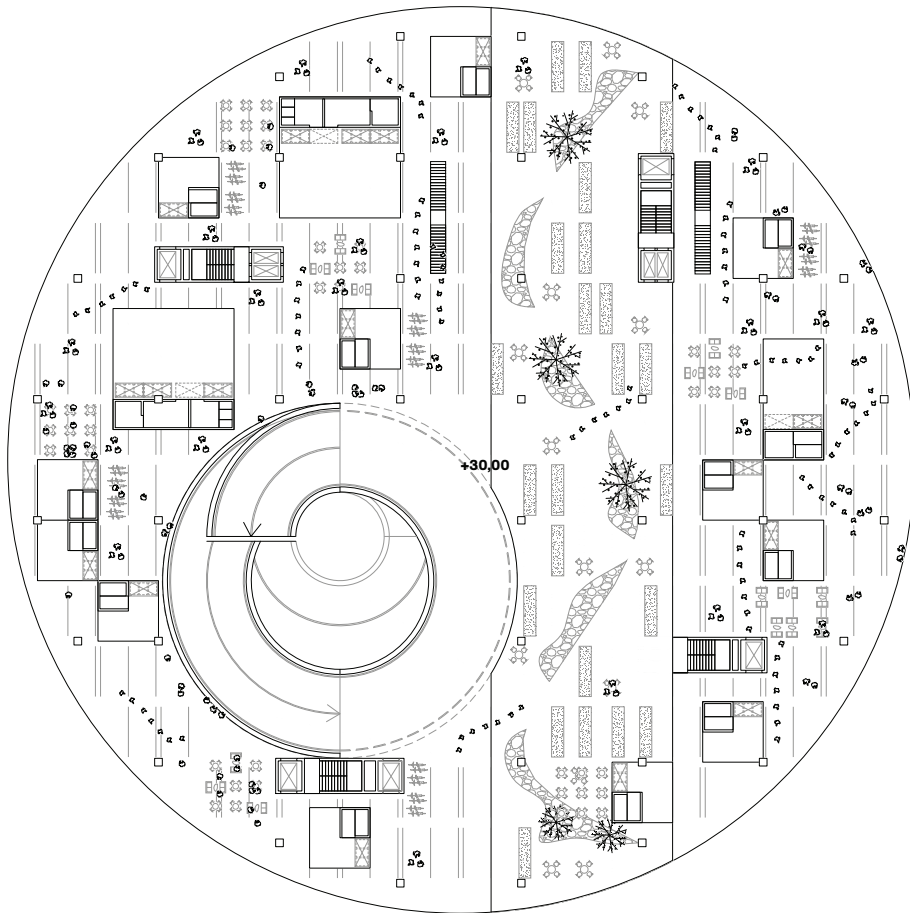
Grundriss . Obergeschoss (+18) . 1:750
